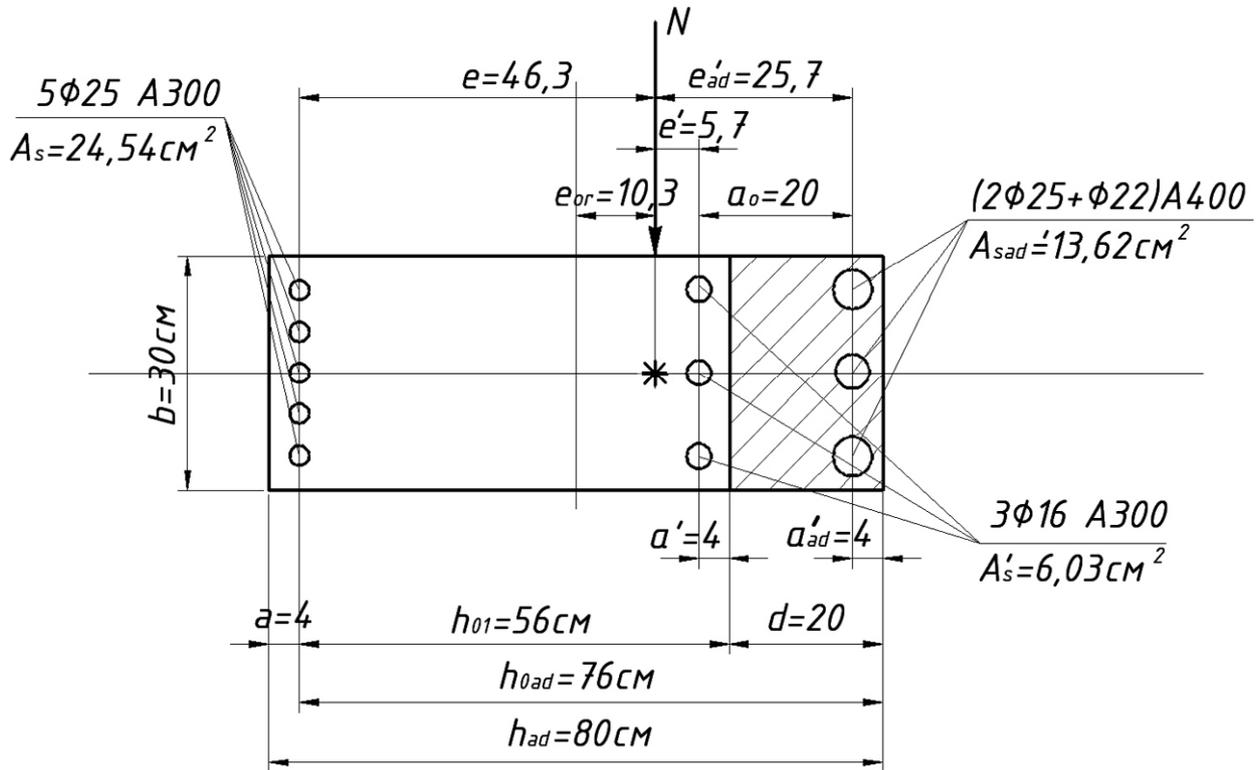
Усиление внецентренно сжатой колонны с малым эксцентриситетом наращиванием со стороны сжатой зоны бетона
